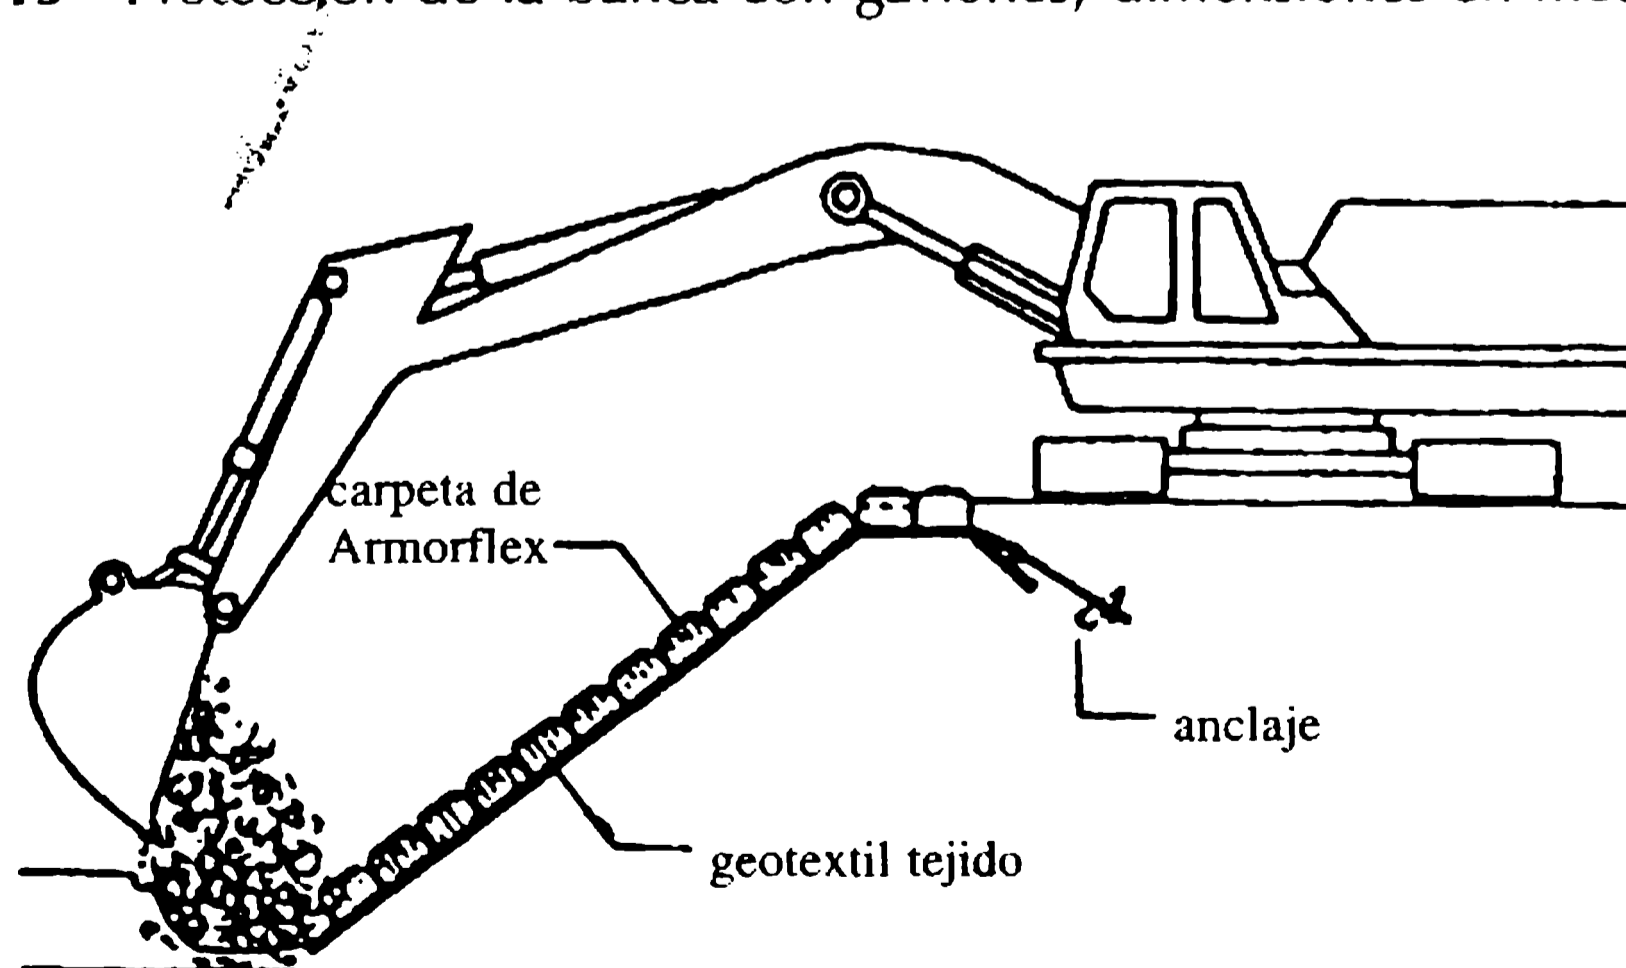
Protección de la banca con revestimientos flexibles de elementos de concreto.
